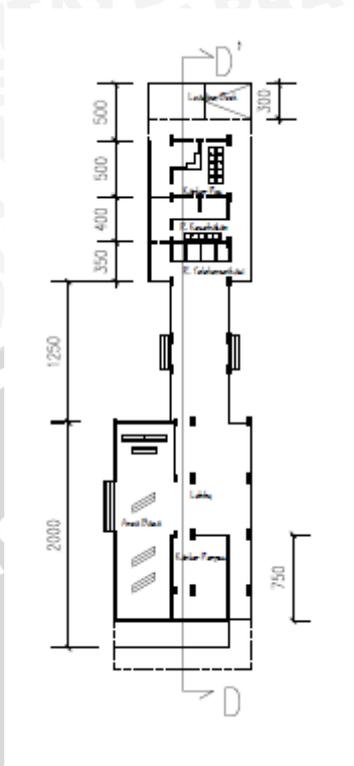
Denah Fasilitas Umum Dan Pengelola Lantai 1
